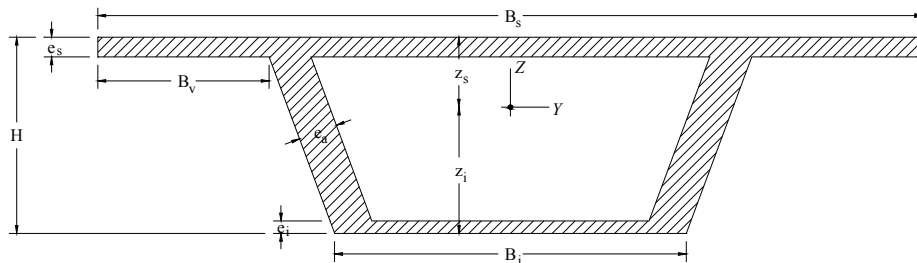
Sección transversal habitual de un puente lanzado.
